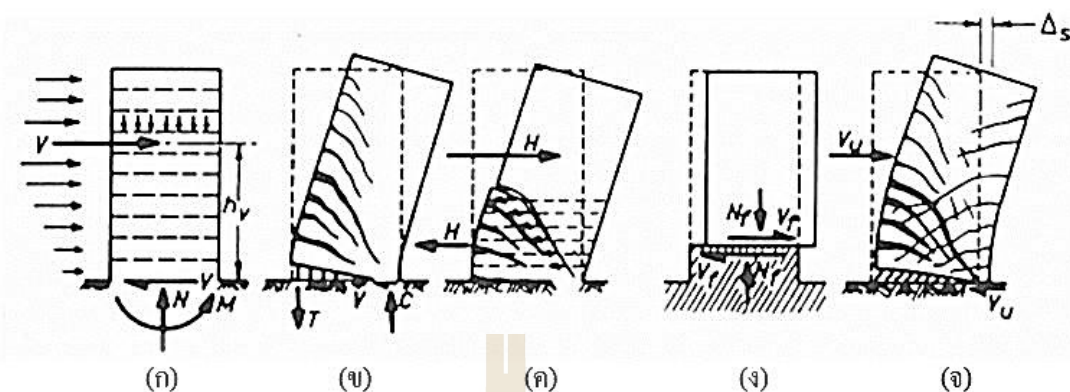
กำแพงไม่มีช่องเปิดหรือ Cantilever structure wall
